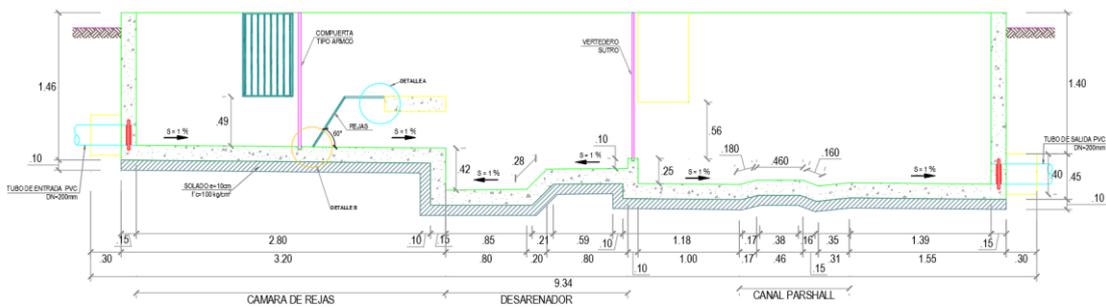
Sección A-A de Cámara de Rejas, Desarenador y Canal PARSHALL
